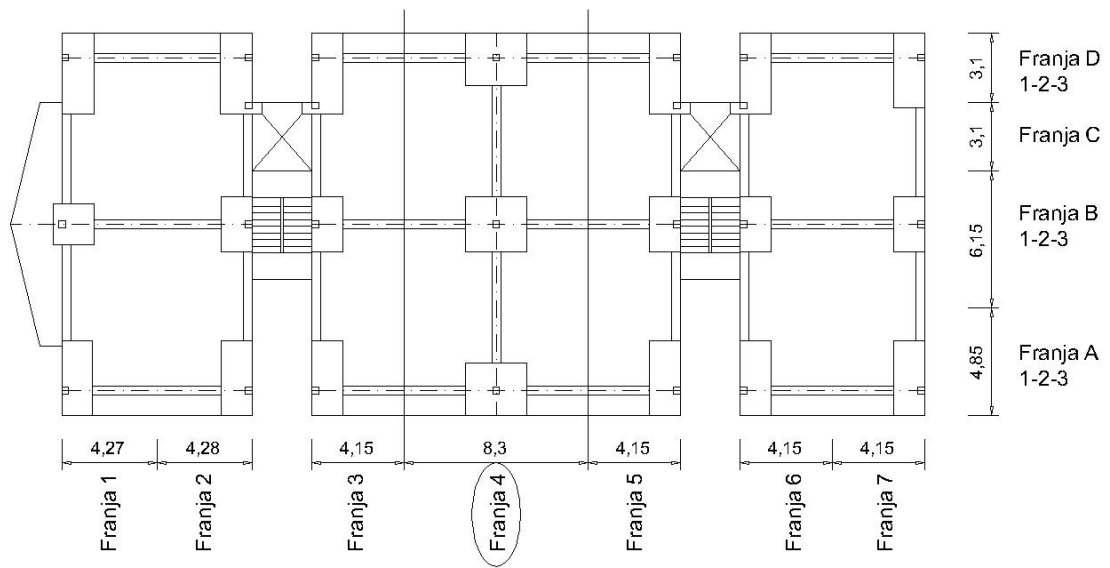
Franjas de diseño de la planta tipo. (Montaño, 2006)
